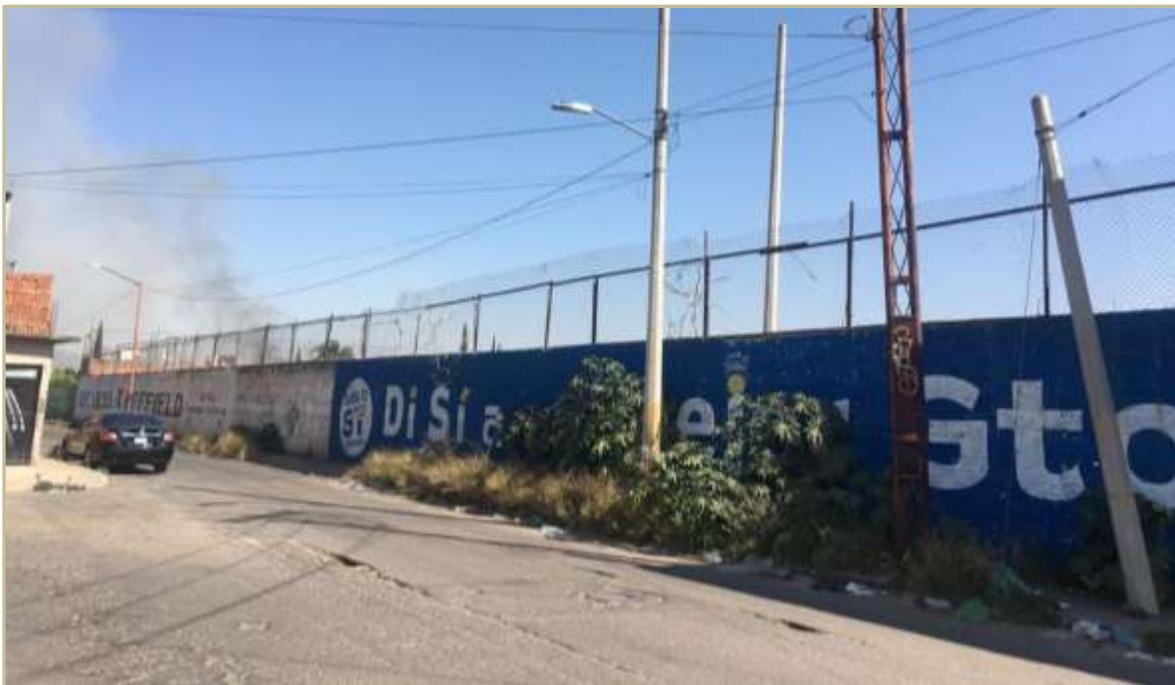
a)-2. Vista desde la calle Santa Cecilia hacia la colindancia Norte, en donde se aprecia la otra fracción del predio, la cual cuenta con muro de ladrillo.
